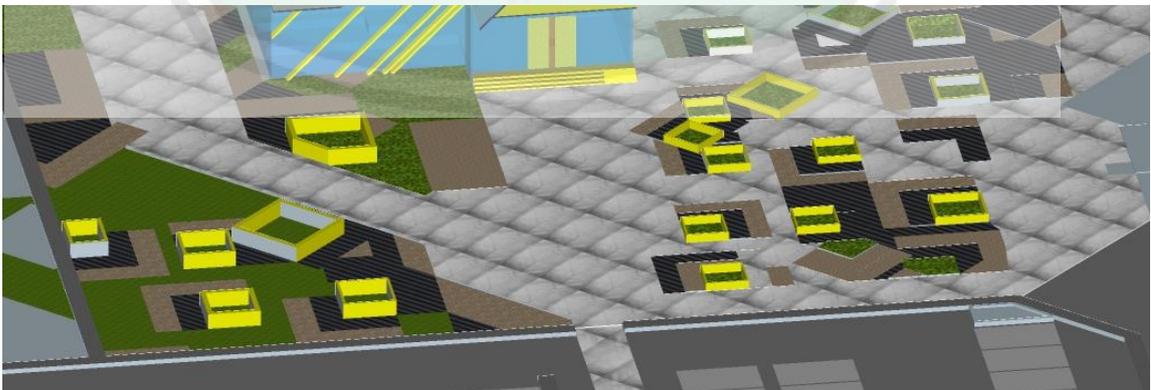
denah ruang penyimpanan sementara bagian timur
